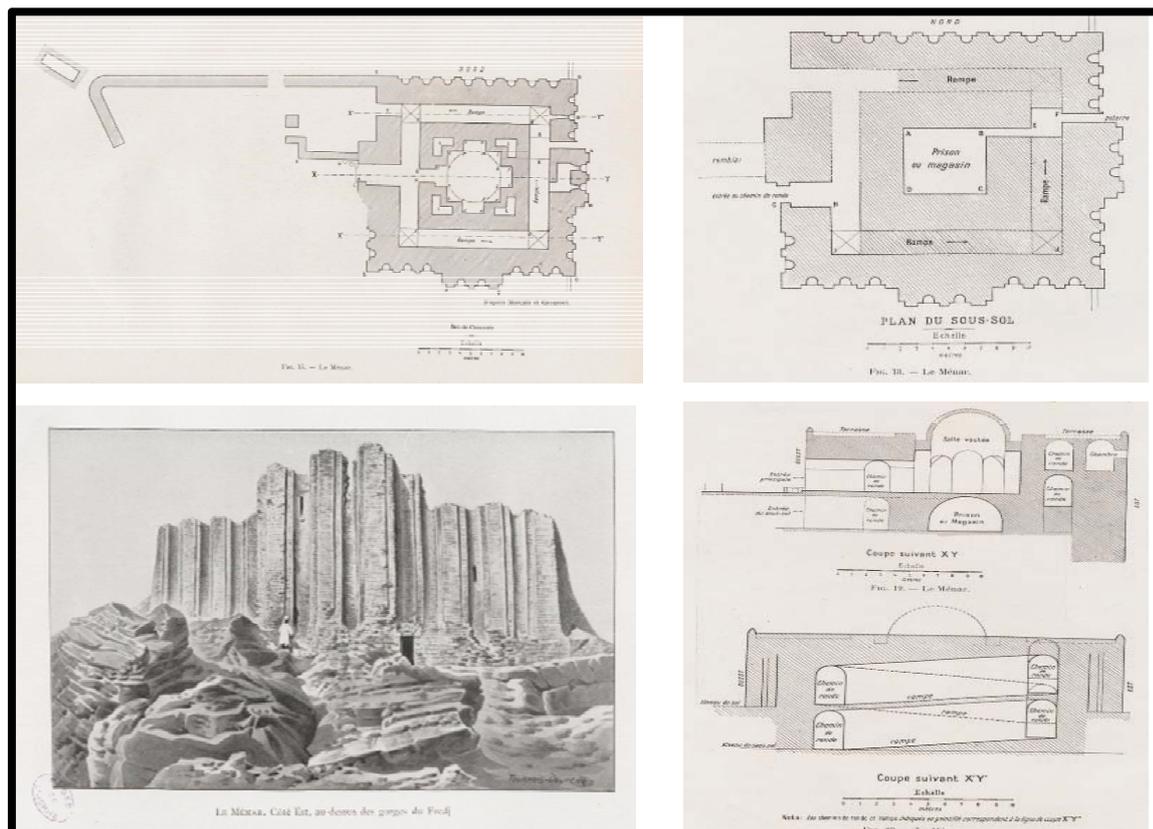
Plan, coupe et élévation du donjon d’el Manar
